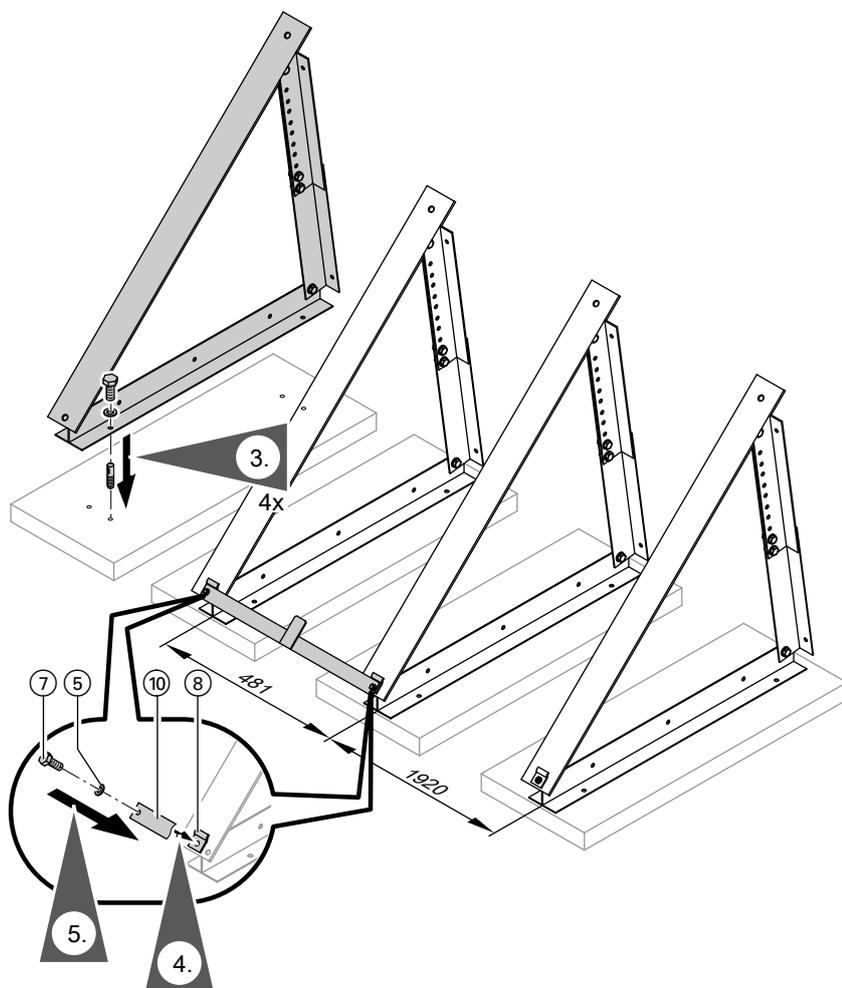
Использовать опорные стойки в качестве шаблона для сверления.
